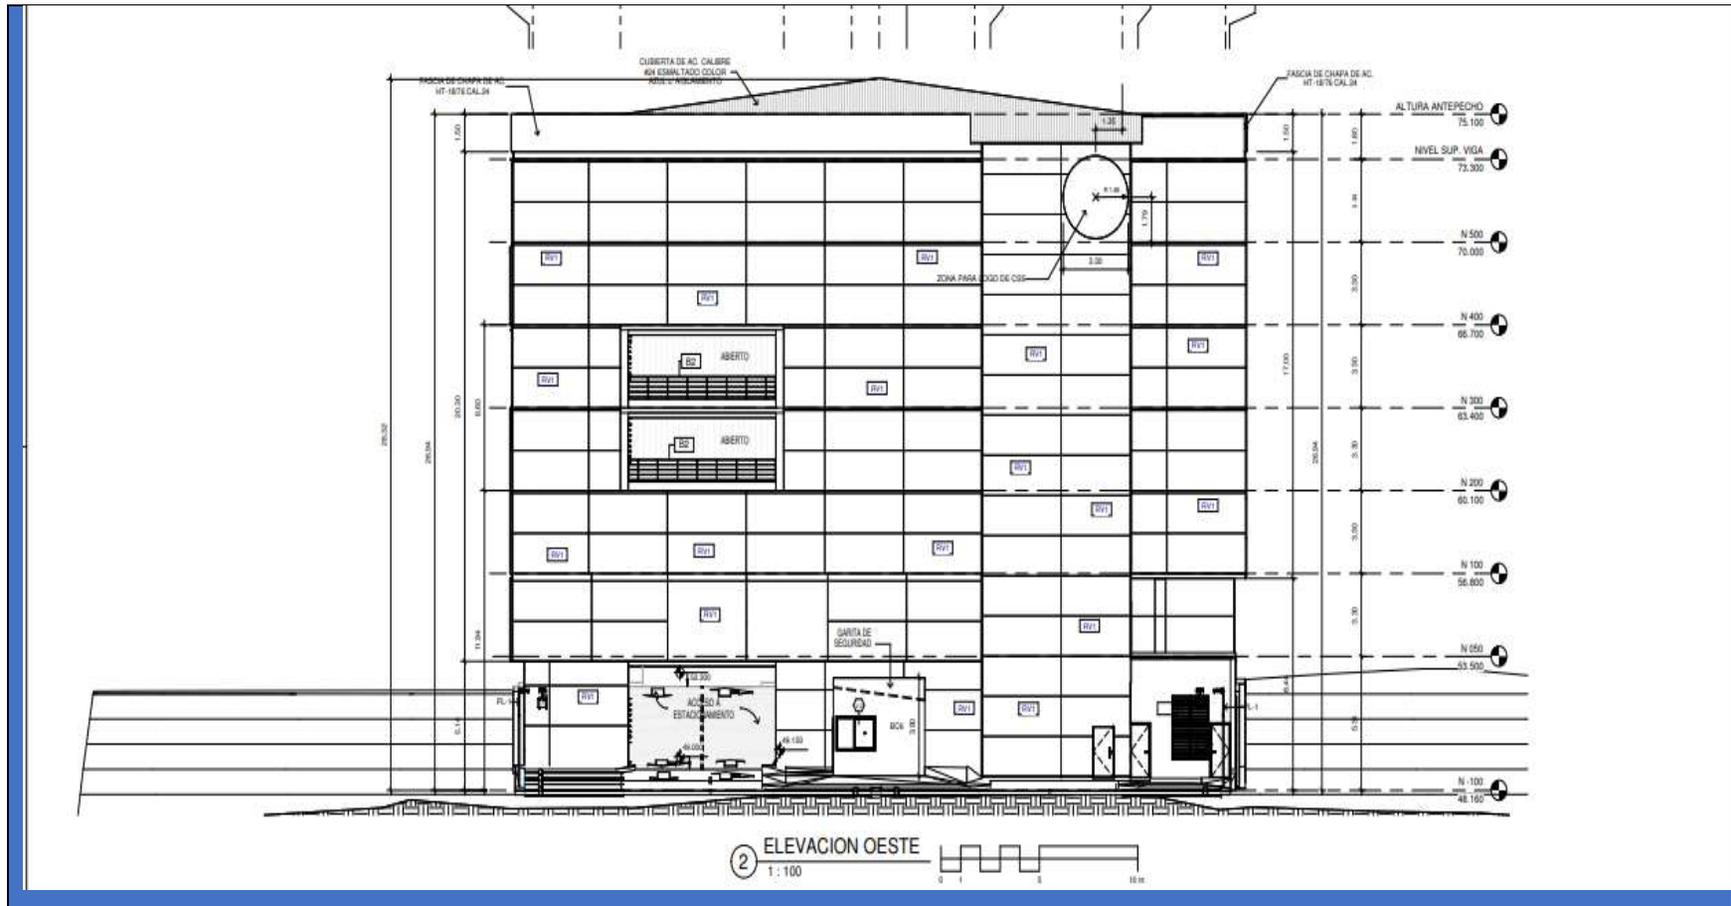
Perfil de Elevación Oeste del edificio de estacionamientos. Fuente: planos de proyecto
